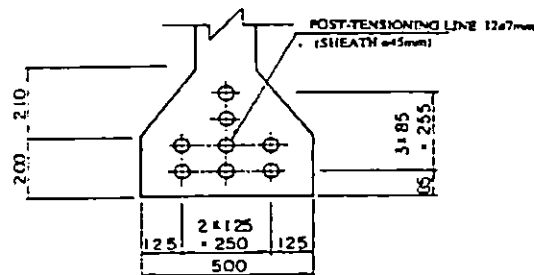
DETALLES DE LAS VIGAS.
